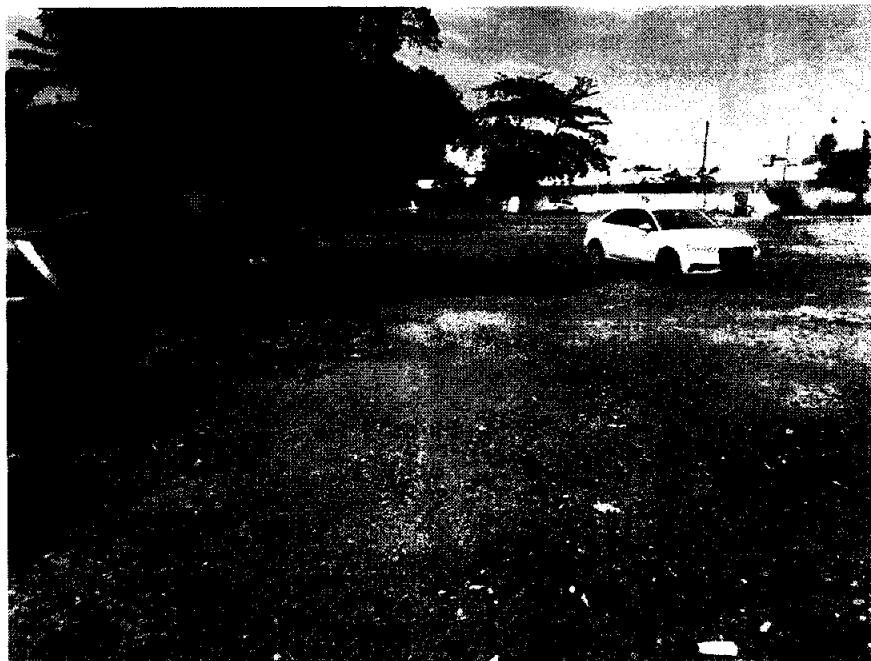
Foto do Terreno onde se localiza a Seção "B"
